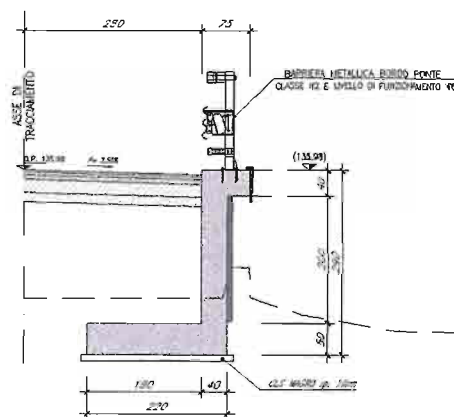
Sezione trasversale muro Tipo C (Prog.140)
